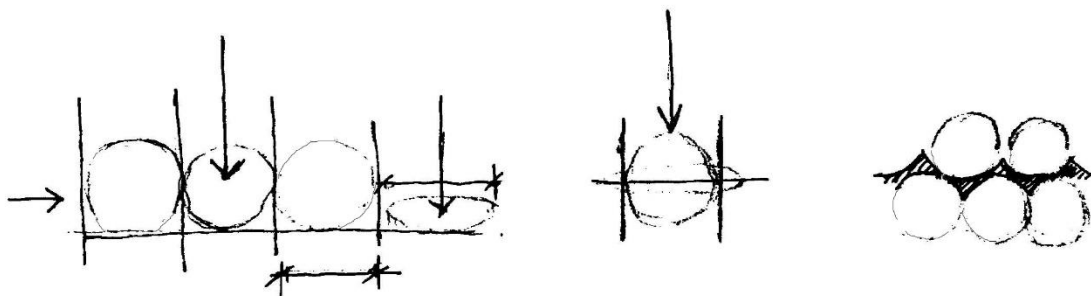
Croquis funcionamiento muro WCM. Fuente. Elaboración propia.
